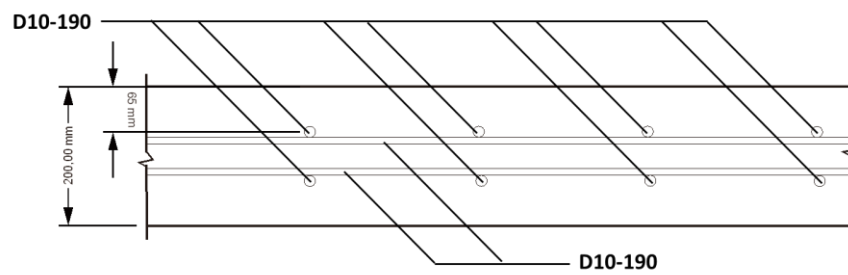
Detail tulangan potongan pilecap fender dermaga arah melintang
